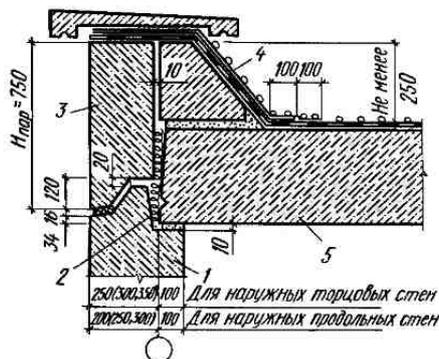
Узел примыкания комплексной легкобетонной панели покрытия к стене:
